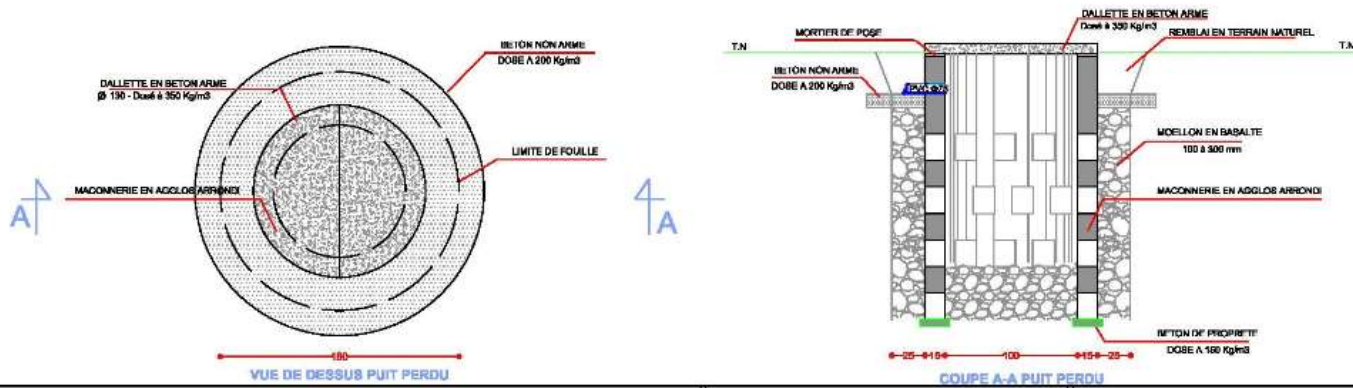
Schéma type d'un ouvrage d'assainissement autonome
